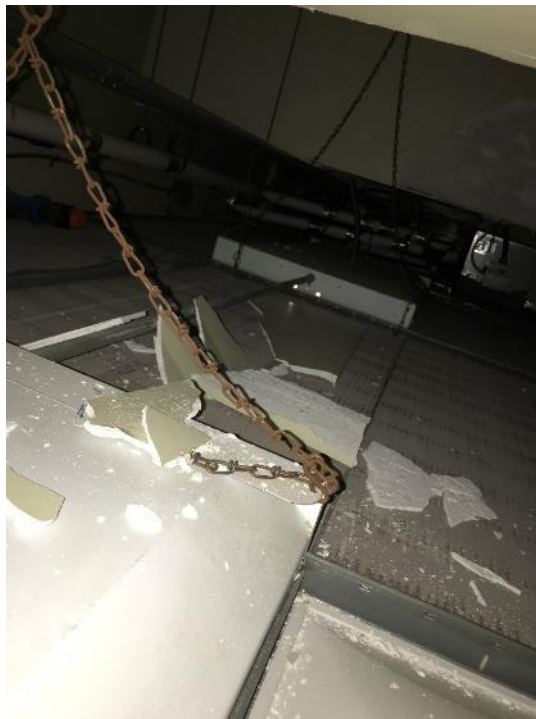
Salle 1059, plâtre du plafond en mauvais état et débris de plâtre reposant sur les carreaux de plafond
